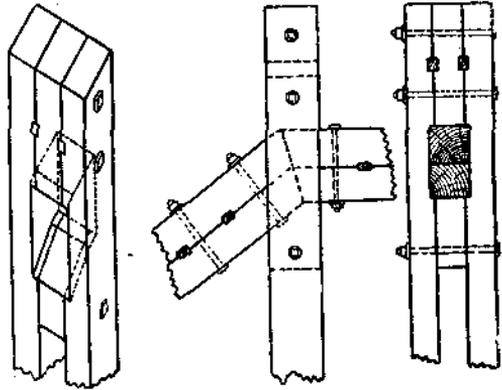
соединение бабки со стропильной ногой и ригелем в ферме с двумя бабками; фиг. 511 — тоже, когда ферма с двумя бабками служит опорной фермой для стропил.
